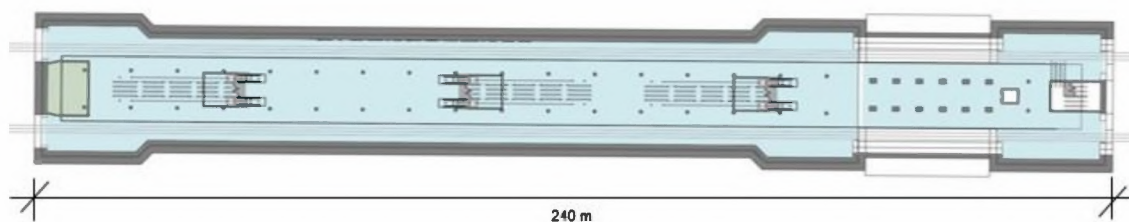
Hp Sternschanze, Var. I – Grundrisse
